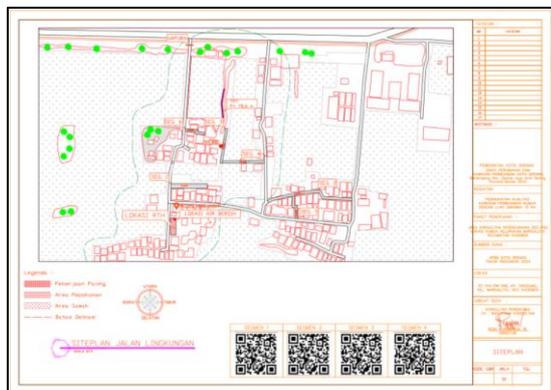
DED Siteplan RTLH Kelurahan Margaluyu
